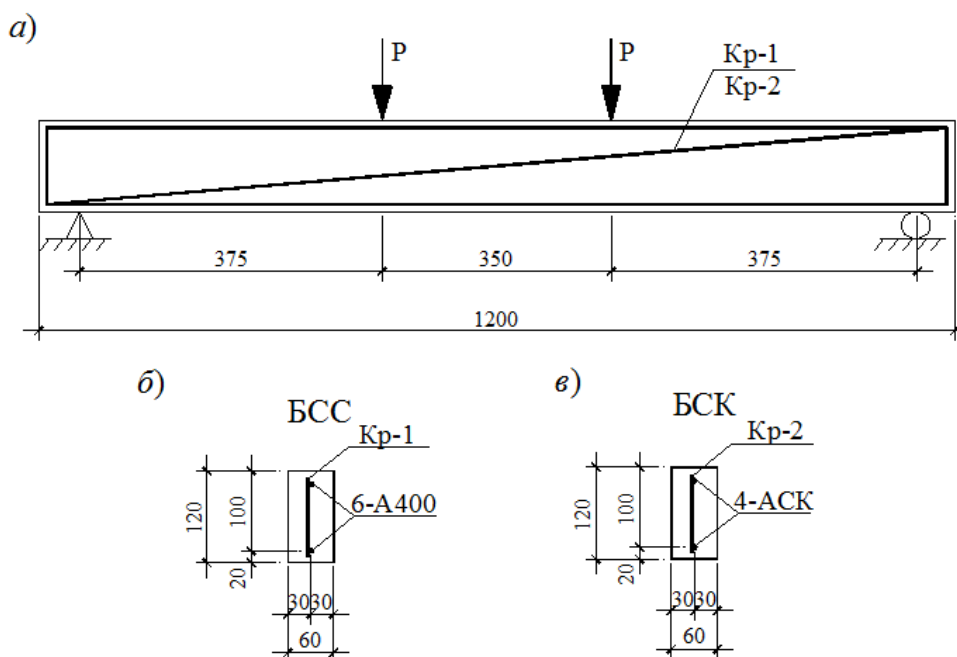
Схема армирования экспериментальных балок: а – расчётная схема конструкции; б – поперечное сечение образцов со стальной арматурой типа БСС; в – поперечное сечение образцов со стеклопластиковой арматурой типа БСК
